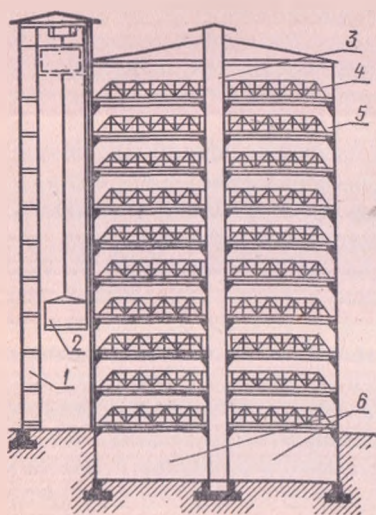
Поперечный разрез 10-этажного животноводческого здания (ГДР):
